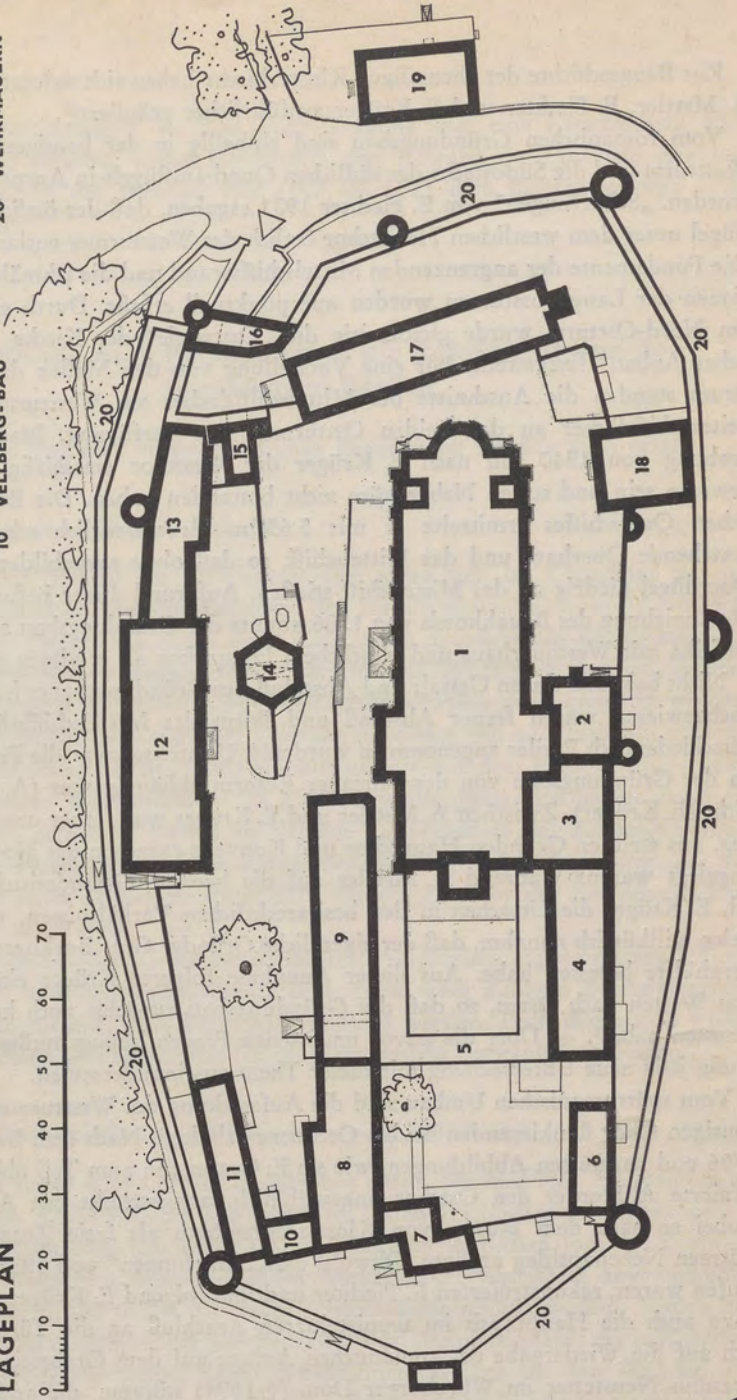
Großkumburg, Lageplan, M. 1:1200.
